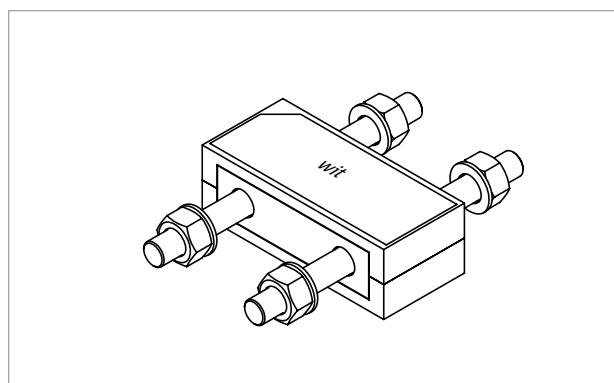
Schöck Isokorb® T type S-N-D16: Vooraanzicht
